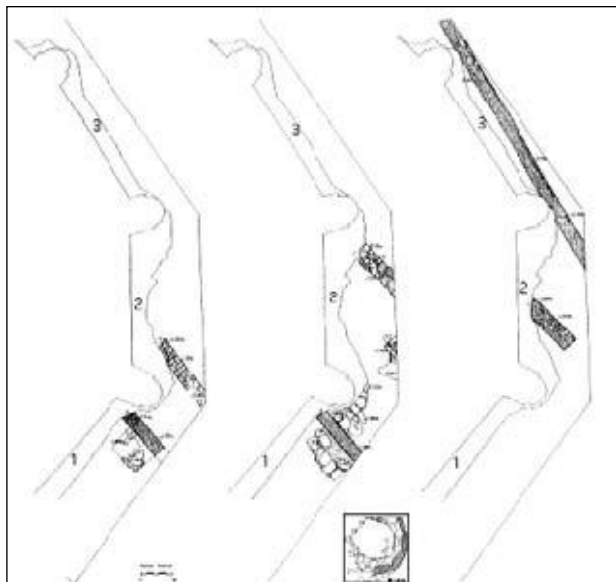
Planta de estructuras en el exterior de la capilla de los Vélez. Catedral de Murcia. Indalecio Pozo Fernández.
